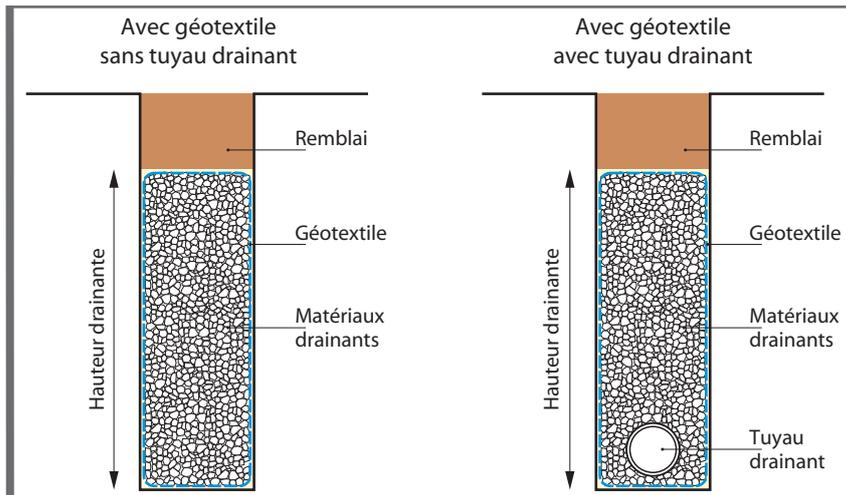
Tranchée drainante sans (à gauche) et avec tuyau drainant (à droite)
